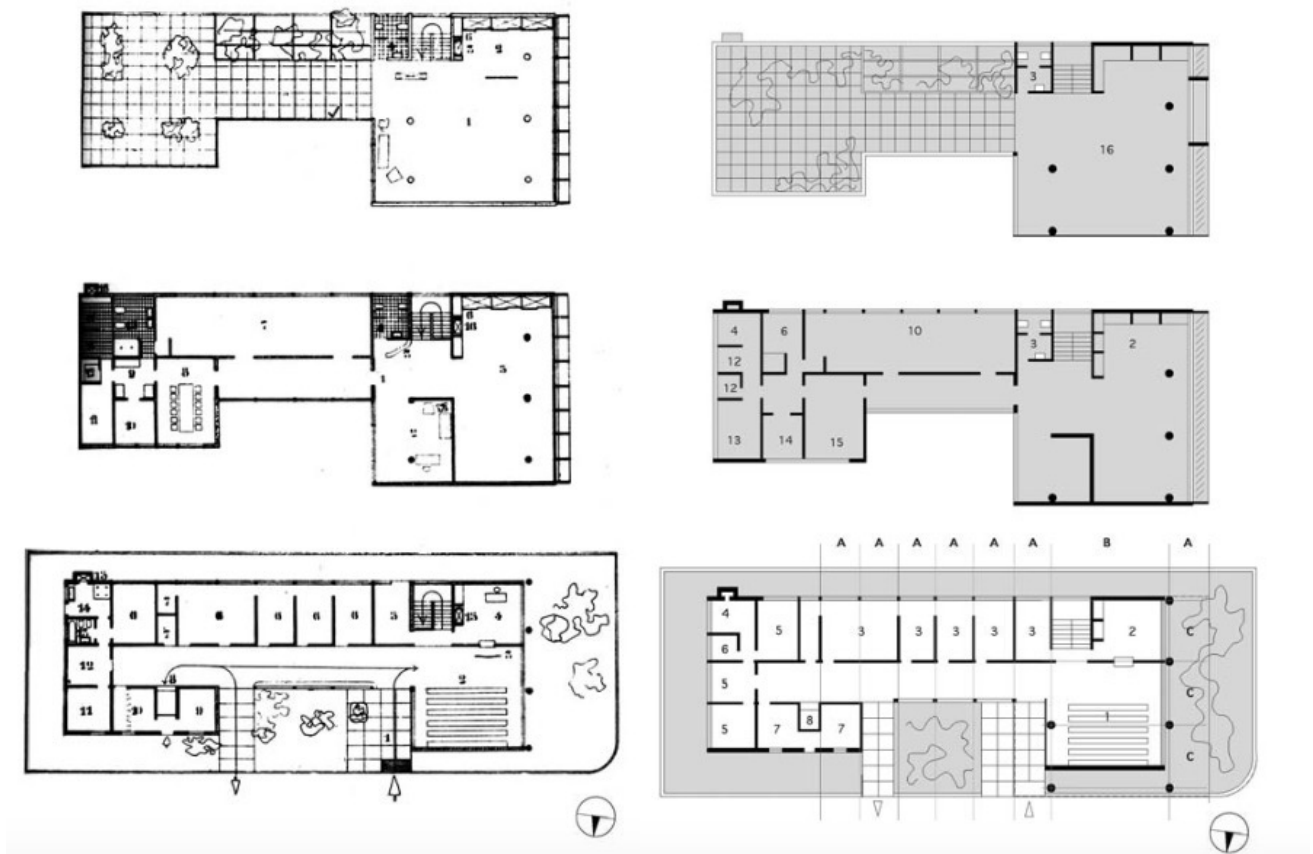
Obra do Berço. Esquerda: Plantas baixas da primeira versão do projeto, 1937. FONTE: MINDLIN, 2000. Direita: Plantas baixas de conformidade à obra construída. VASCONCELLOS, 2004.
